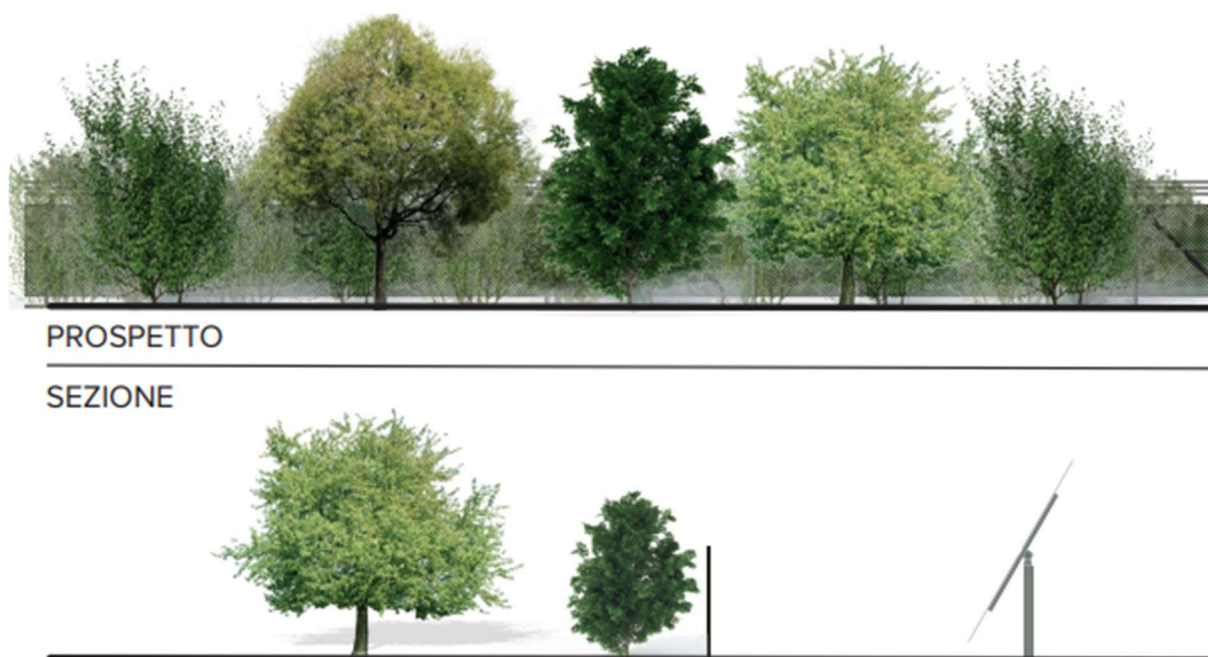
Fascia vegetata a due file parallele sfalsate prevista dal progetto
